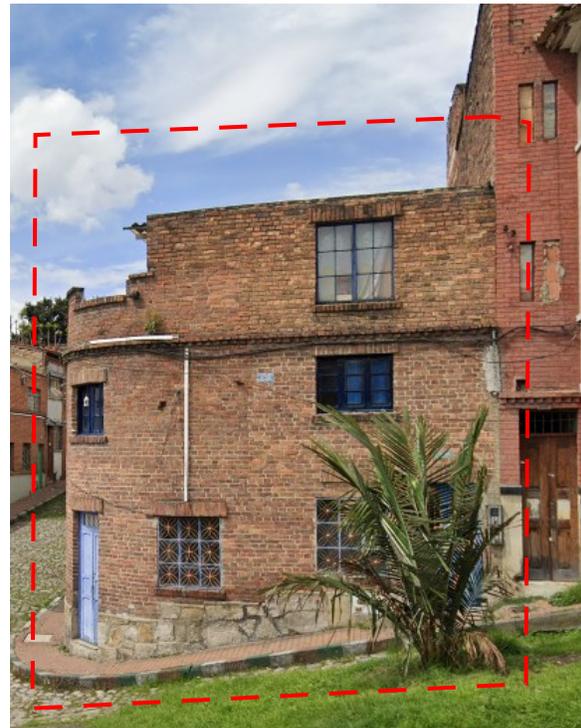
(Izquierda). Fachada general del inmueble ubicado en la CL 8 1 84 – Situación a octubre de 2024.
